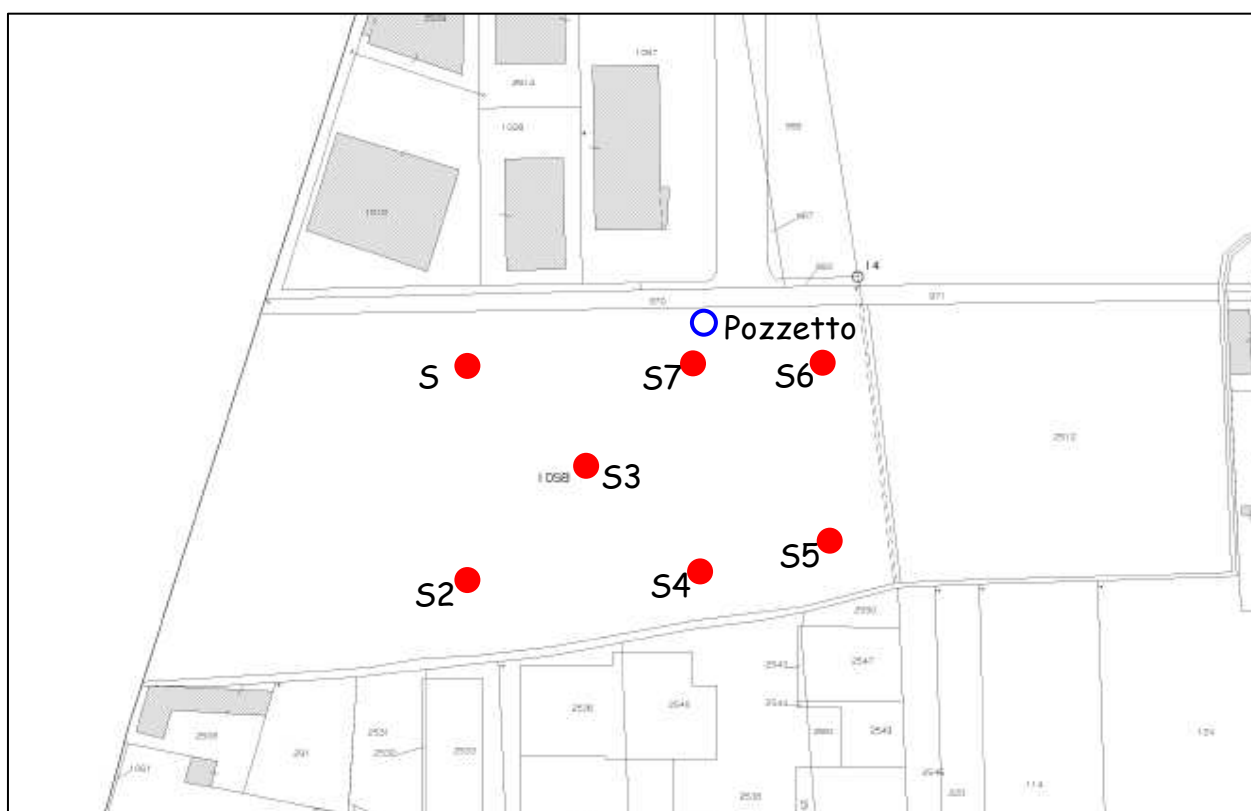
Ubicazione delle prove penetrometriche S.C.P.T. (Estratto da planimetria catastale - non in scala)
